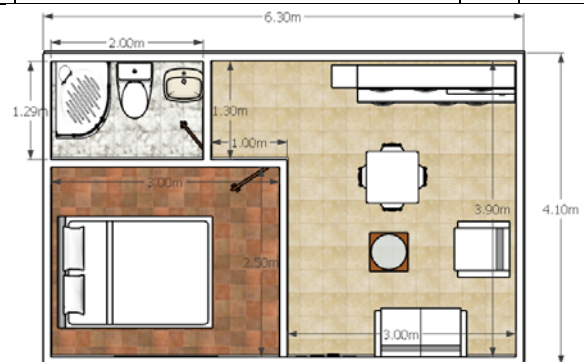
Vista de Planta de VUF 01 25.83 m².
